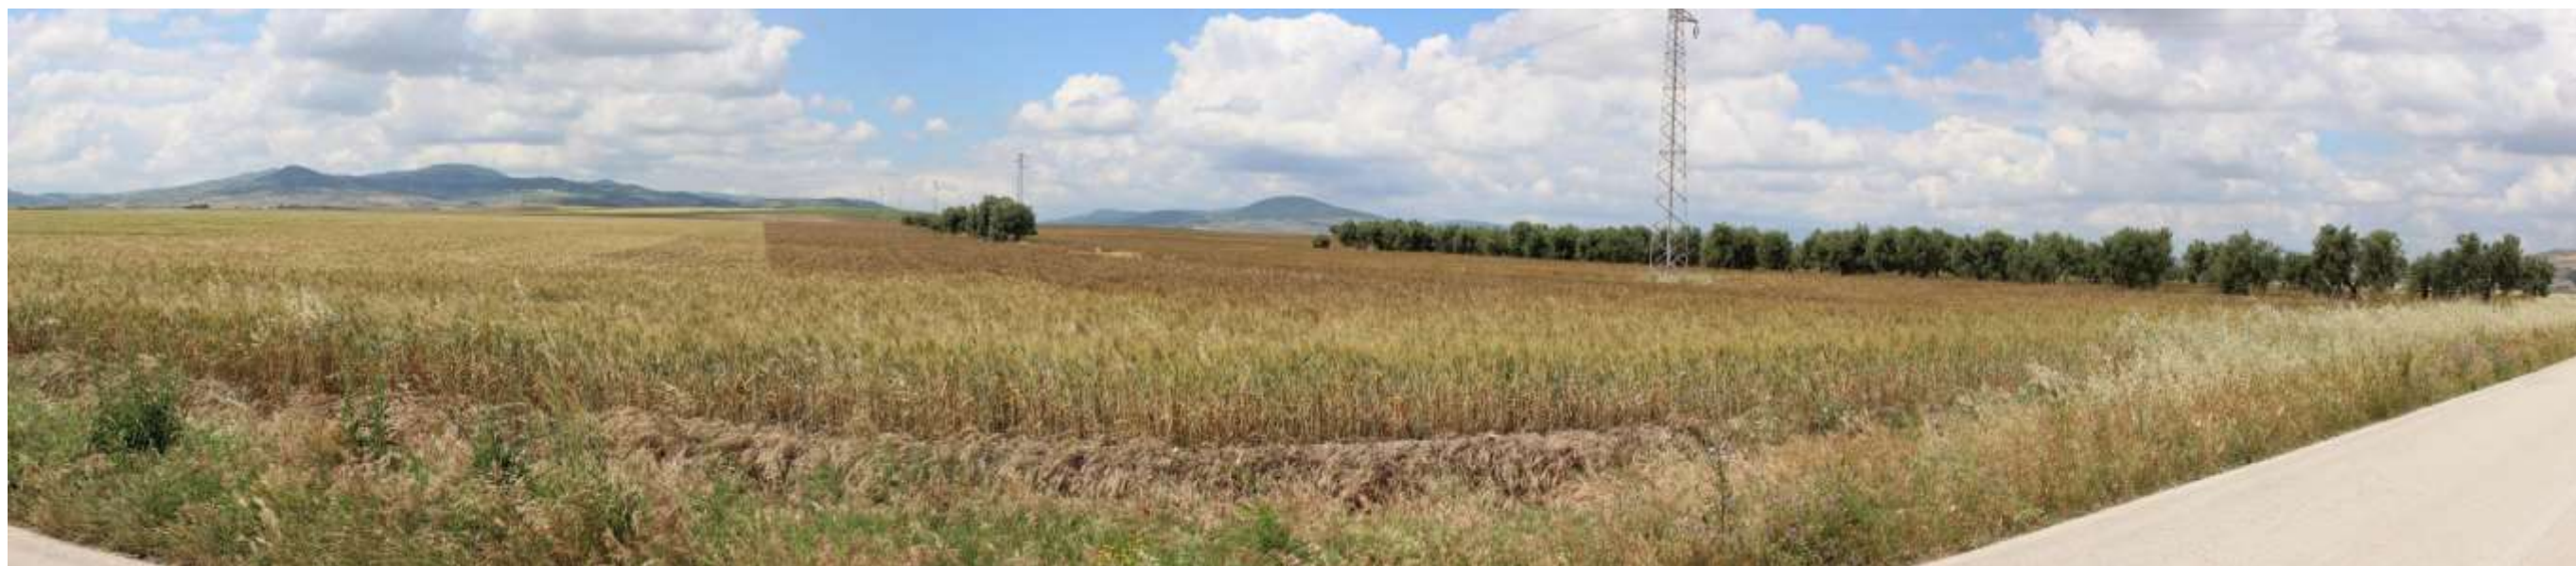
Panoramica dell'area d'intervento vista dalla SP103 nel punto in cui è prevista la realizzazione della strada di accesso alle torri A3_A4_A5_A6_A7
